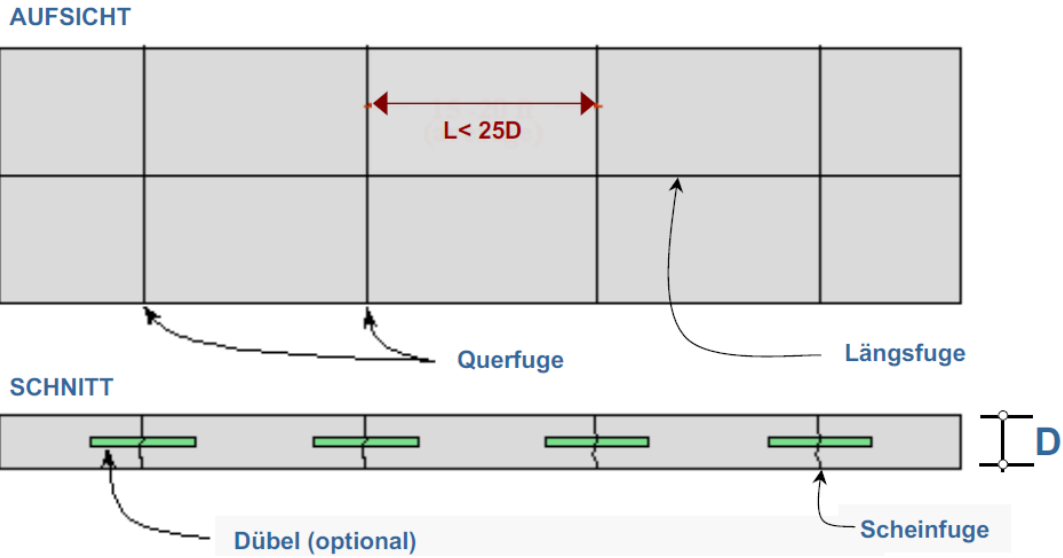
Betondecke ohne Raumfuge, unbewehrt [5]
